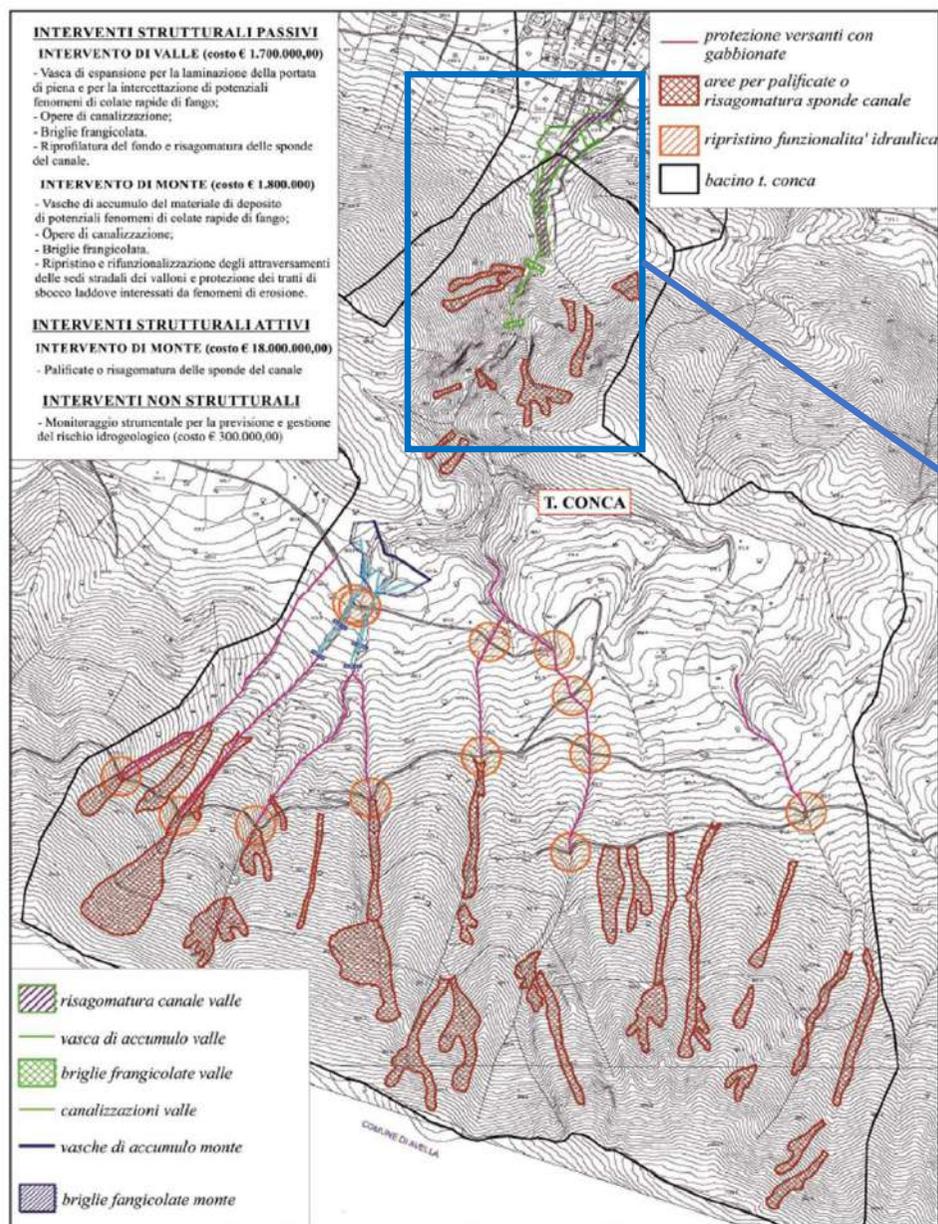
Master Plan degli interventi strutturali e non strutturali del Bacino del Torrente Conca
